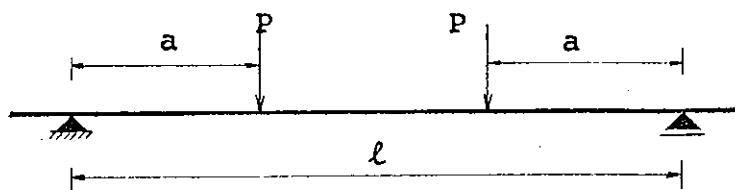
Esquema de carregamento das vigas V15B, V25B, V30B e V25B*.
